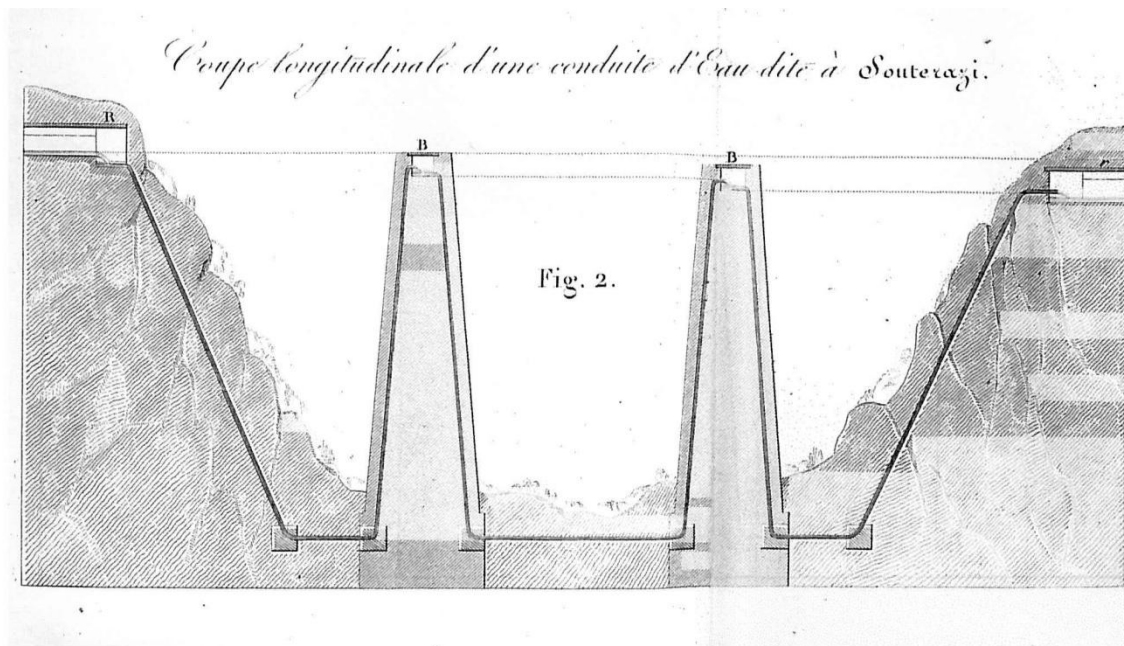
Coupe longitudinale d'une conduite d'eau à *souterazi* ; représentation par Raymond Génieys dans son ouvrage « *Essai sur les moyens de conduire, d'élever et de distribuer les eaux* », planche IV. Il s'agit d'une reprise améliorée de la planche III et IV de l'Atlas d'Antoine-François Andréossy. Ici la conduite est en plomb tandis que celles à *souterazi* d'Alger et celles du Maghreb d'une manière plus générale, sont en céramique. L'ouverture au sommet permet de chasser l'air dans la conduite et donc de diminuer la pression intérieure. Cette planche est sans échelle mais explique clairement le fonctionnement du système en question. D'après les premiers levés du Génie (premier rapport des Archives nationales de Paris /10/2380 daté du 10 mai 1847), l'aqueduc de l'Aïn Zeboudja présente des *souterazi* hauts de 8m.
